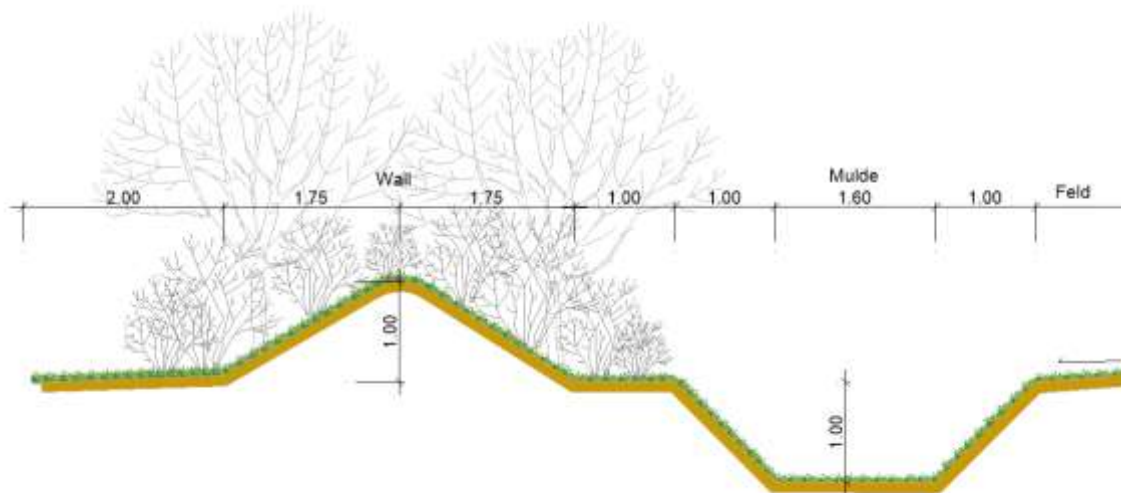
Grabenquerschnitt mit anschließendem Wall
